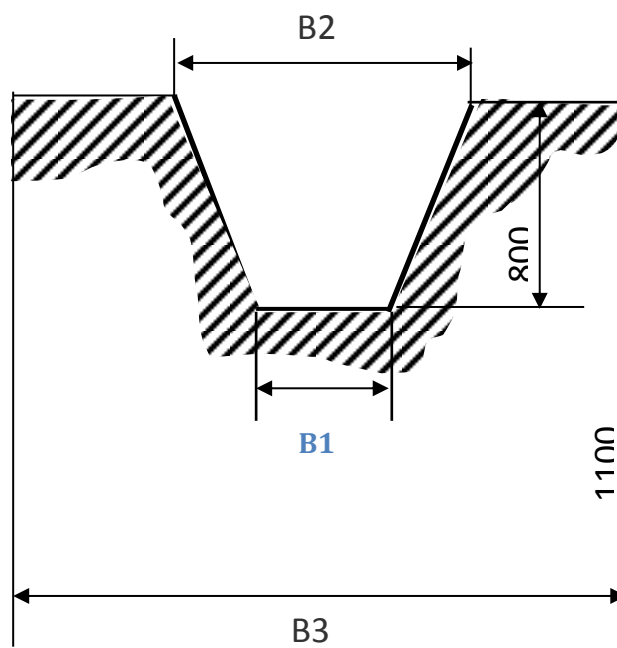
Размеры траншеи для прокладки кабеля
